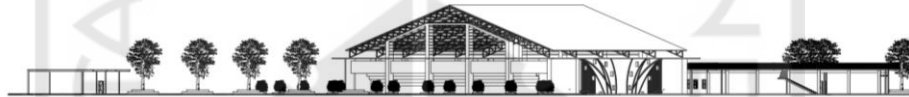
Rancangan siteplan hutan kota dan sporthall
